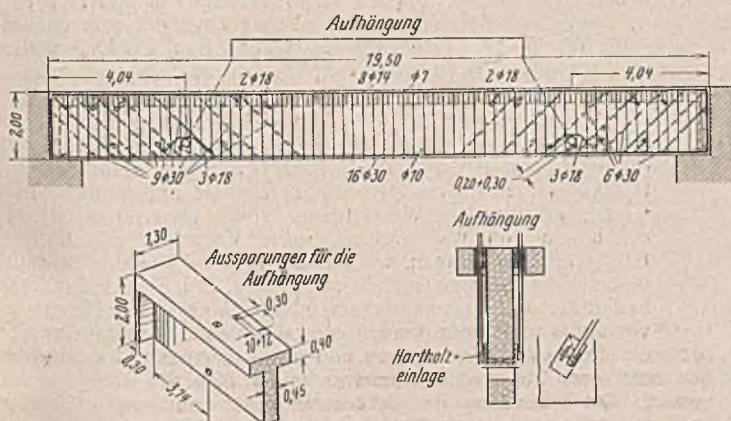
Eisenbetonträger zur Abstellung der Quersenk-kästen.
